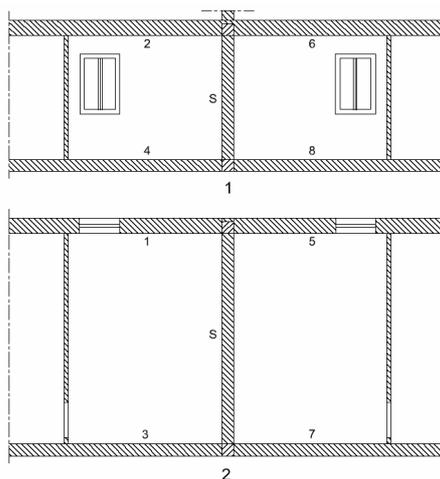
Codifica degli elementi strutturali dei due ambienti in pianta e sezione
